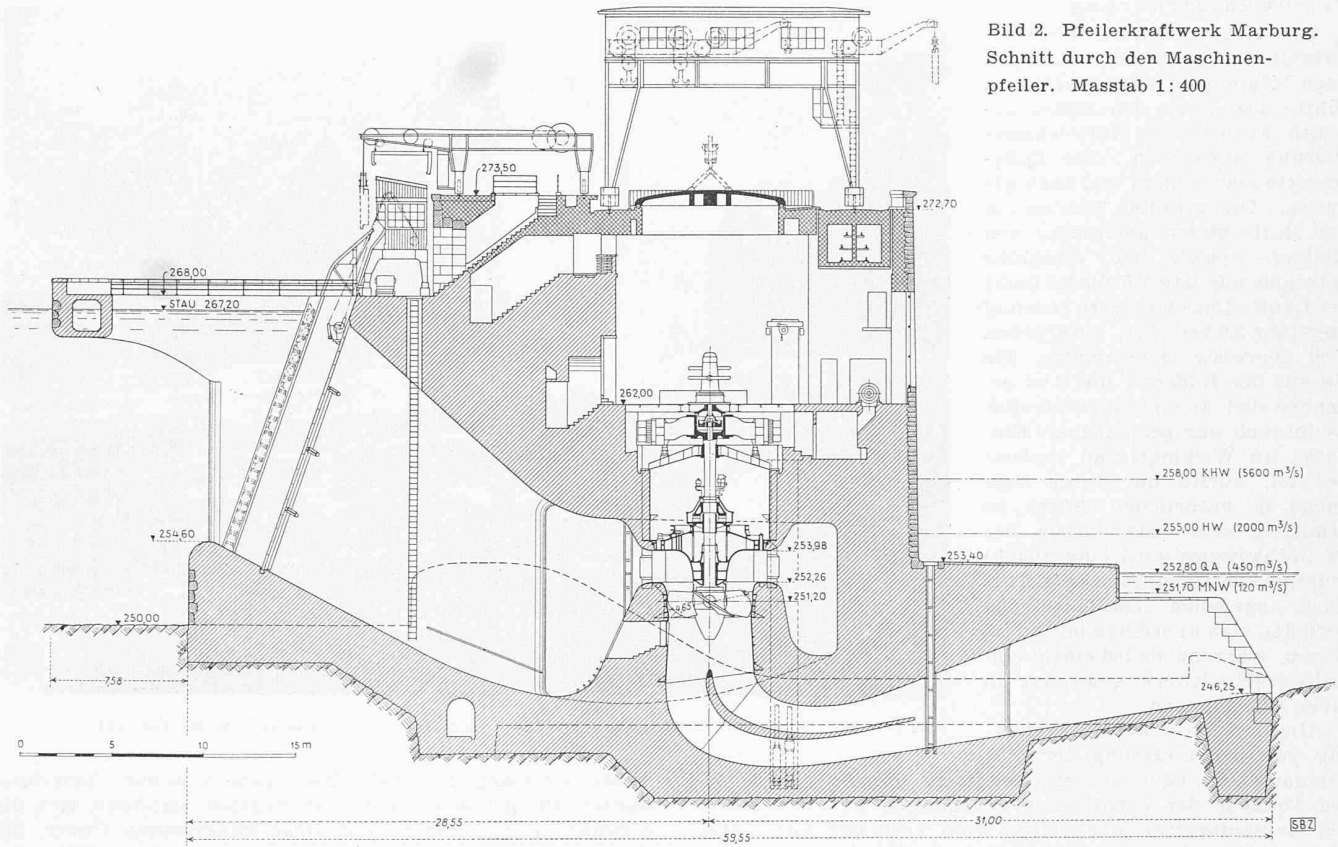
Pfeilerkraftwerk Marburg. Schnitt durch den Maschinenpfeiler. Masstab 1:400
